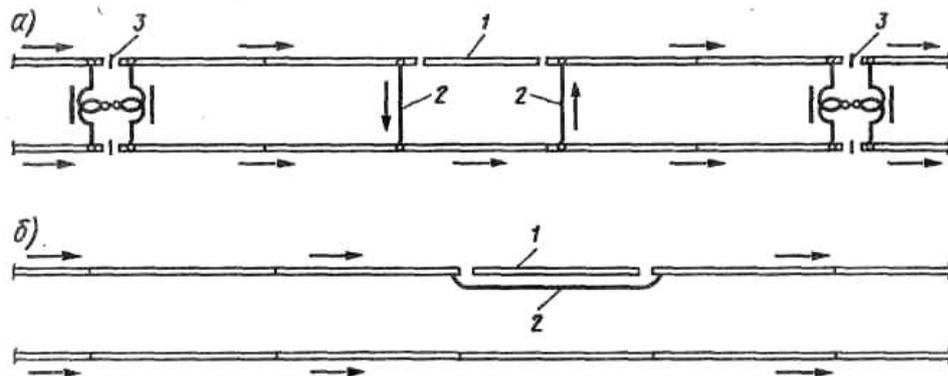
Схемы укладки обходных перемычек при смене рельса:
